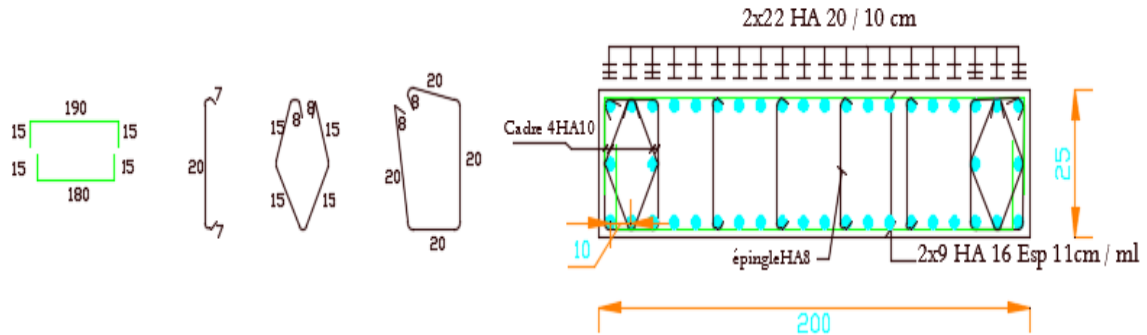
coupe transversale de ferrailage de voile transversale VT1
